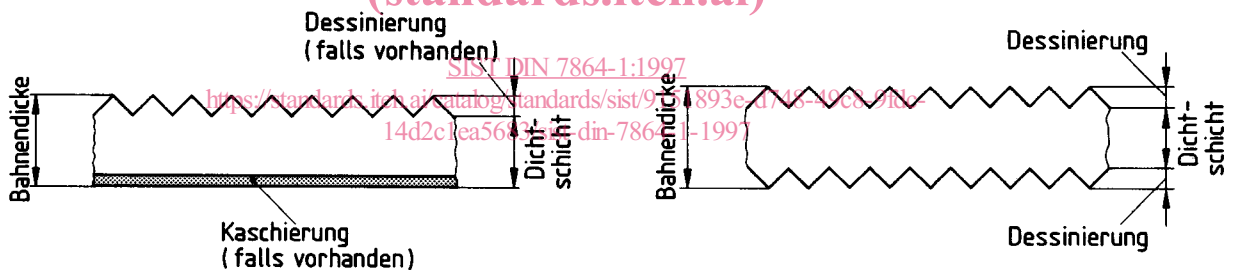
Querschnitt der Elastomer-Bahn mit einseitiger Dessinierung
